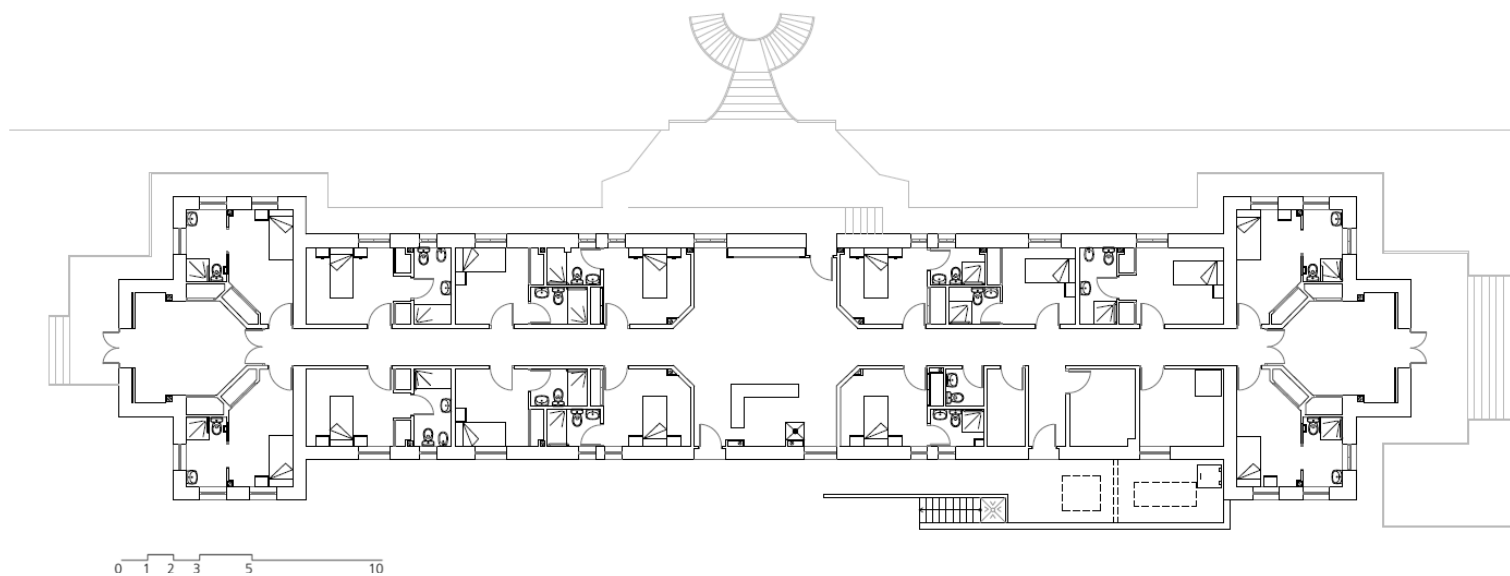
Levantamiento planimétrico del estado actual. Sección Horizontal. Escala Gráfica
